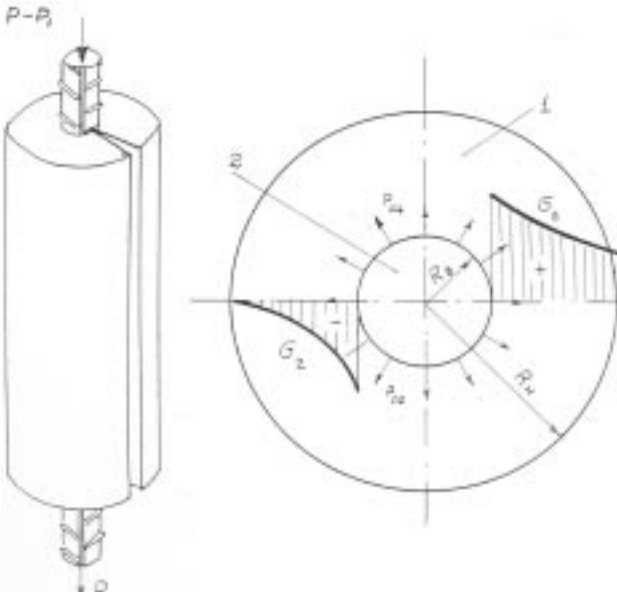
Расчетная схема для определения давления арматуры на бетон: 1 – бетонный образец, 2 – арматура
